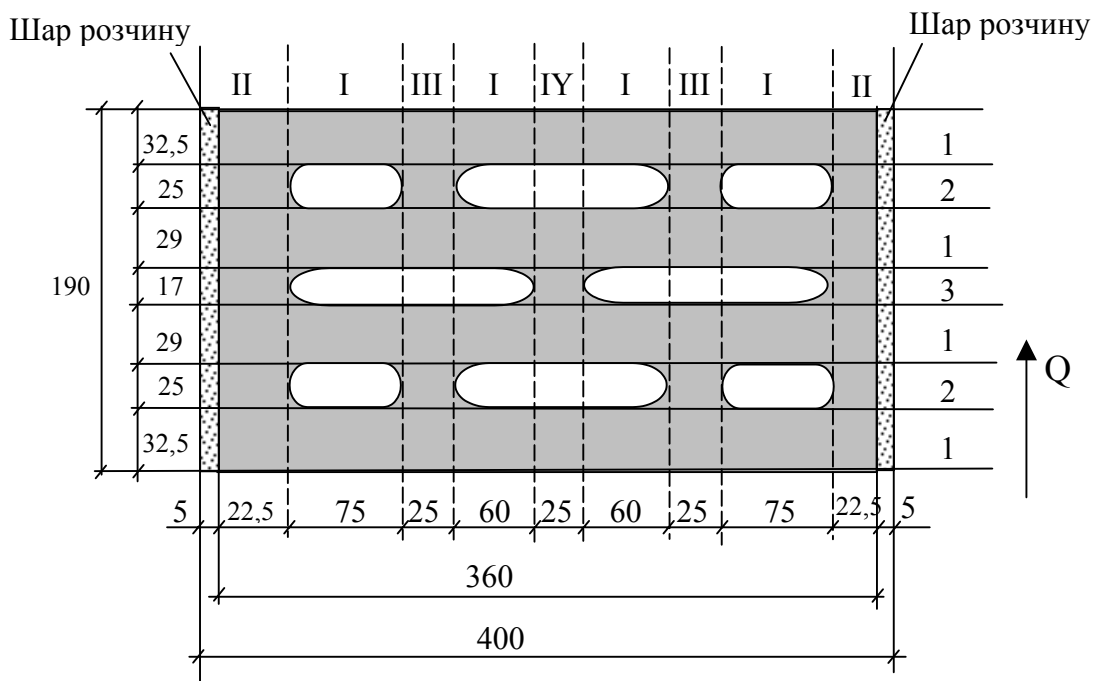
Розрахункова схема шлакобетонного каменю з щілинними пустотами
